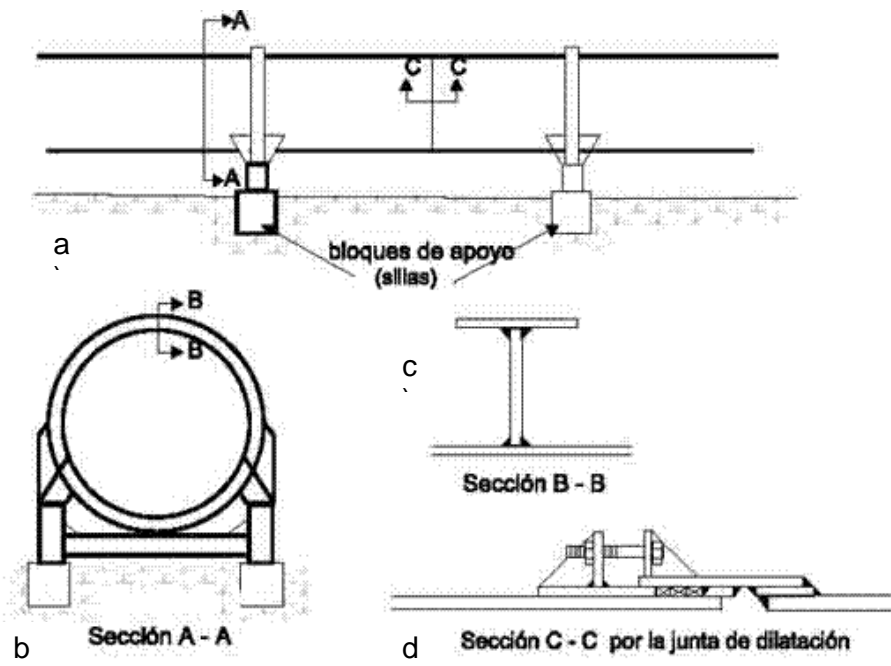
Detalles constructivos para los elementos de fijación de la tubería forzada.
